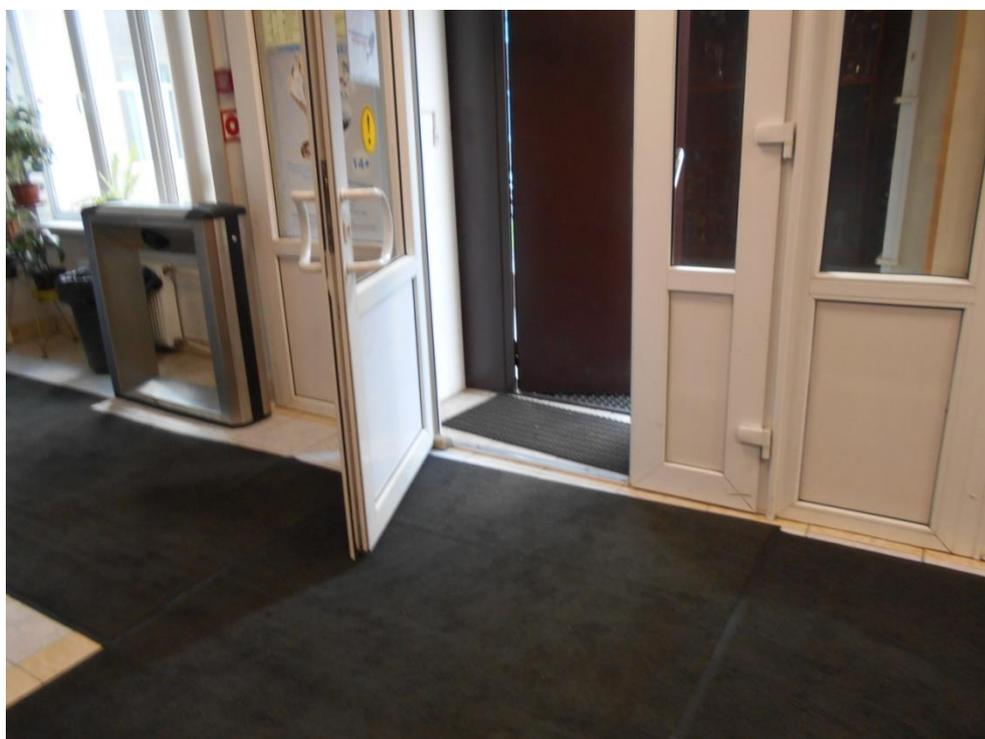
Вход в здание. Отсутствие тамбура. На плане №8
